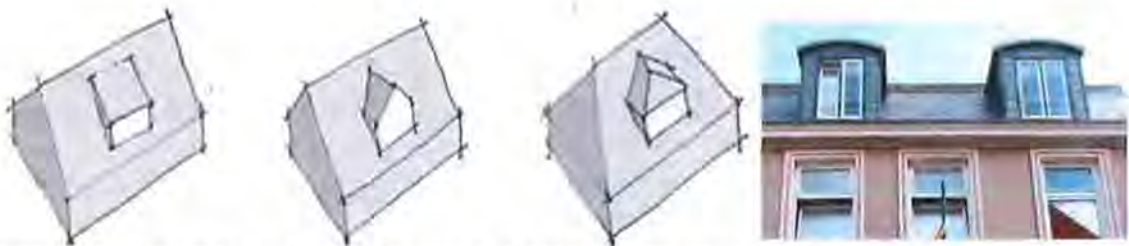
Beispiele für Dachaufbauten in Meldorf (Schleppgaube, Giebel-, Walm- oder Runddachgaube)
